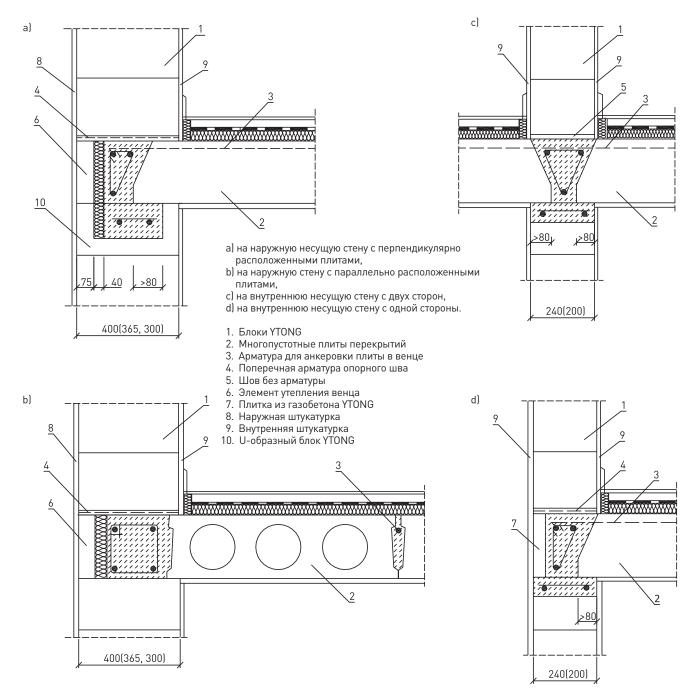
Опирание плит перекрытий многопустотных из обычного тяжелого железобетона
